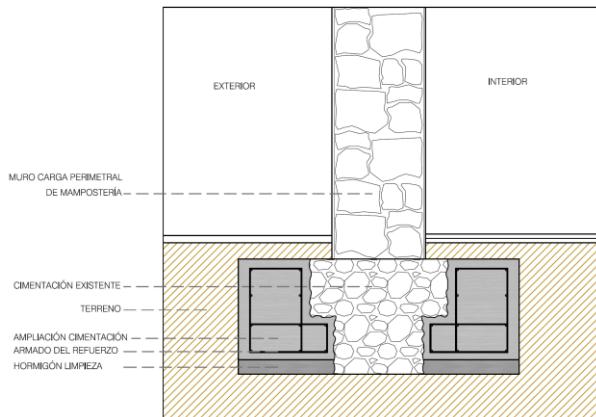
Detalle ampliación de zapata corrida en zona A. 2023. Fuente: propia.
